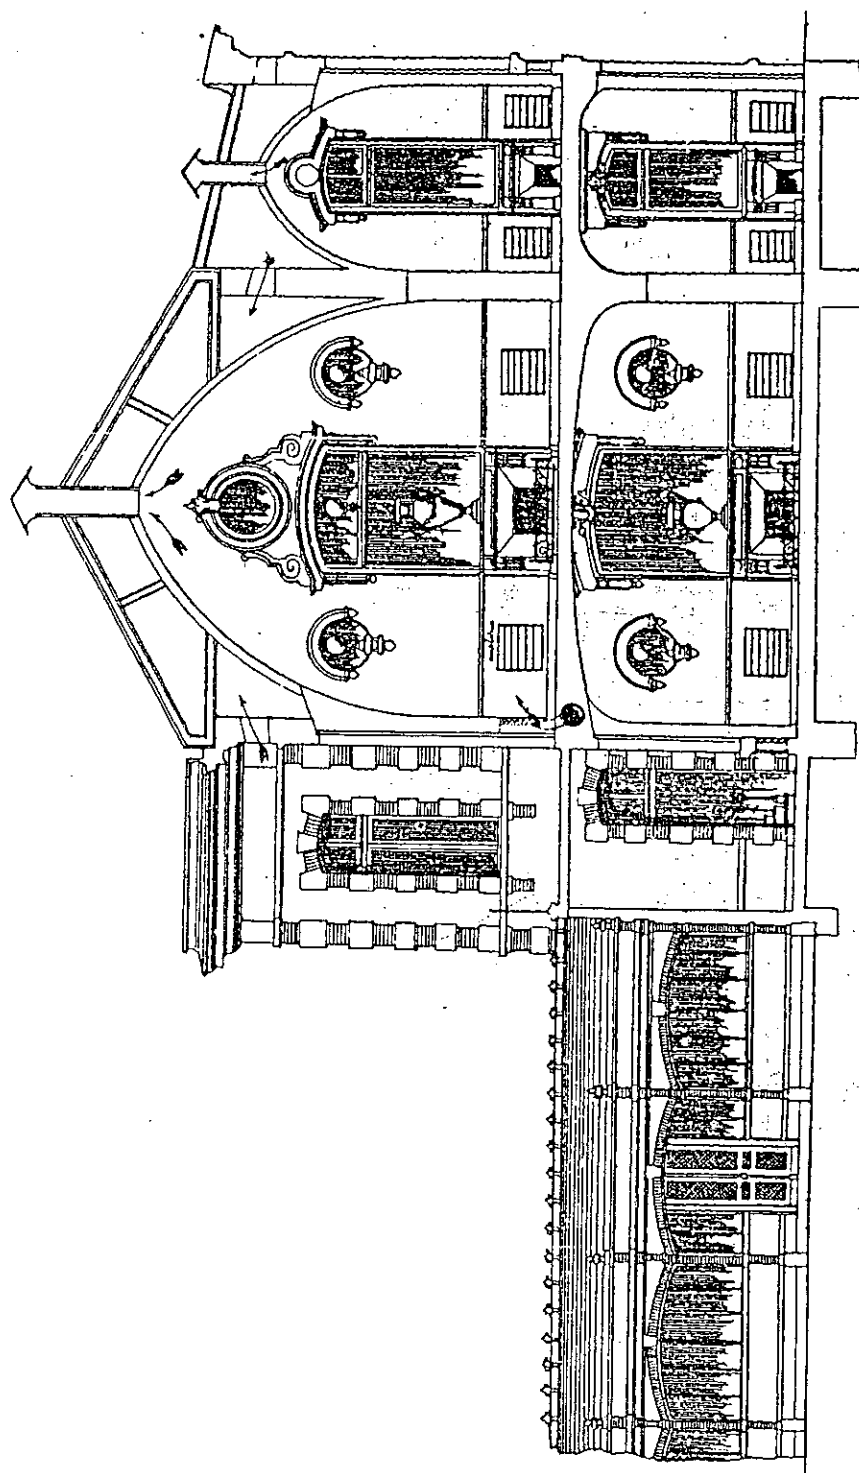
p. — Pavillon de malades ou de blessés. — Coupe transversale sur les petites salles de convalescents, aux extrémités du rez-de-chaussée, avec raccord de galerie de communication. — Échelle de 0,01 p. 1 mètre.
